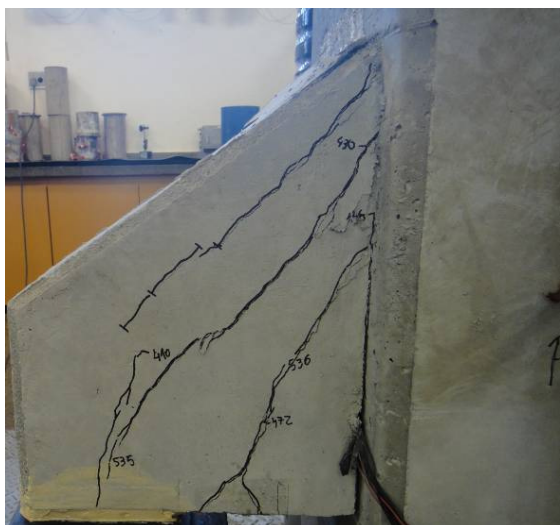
Panorama de fissuração do modelo em duas etapas M9B.
